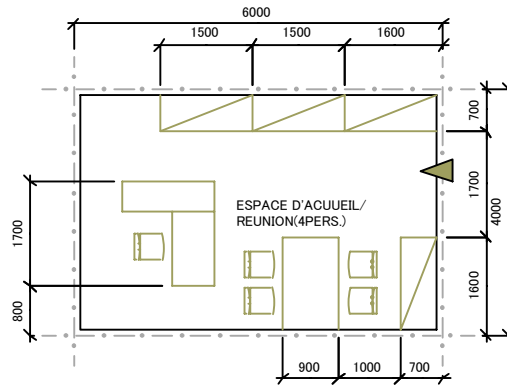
Plan planimétrique du bureau du directeur financier et administratif
